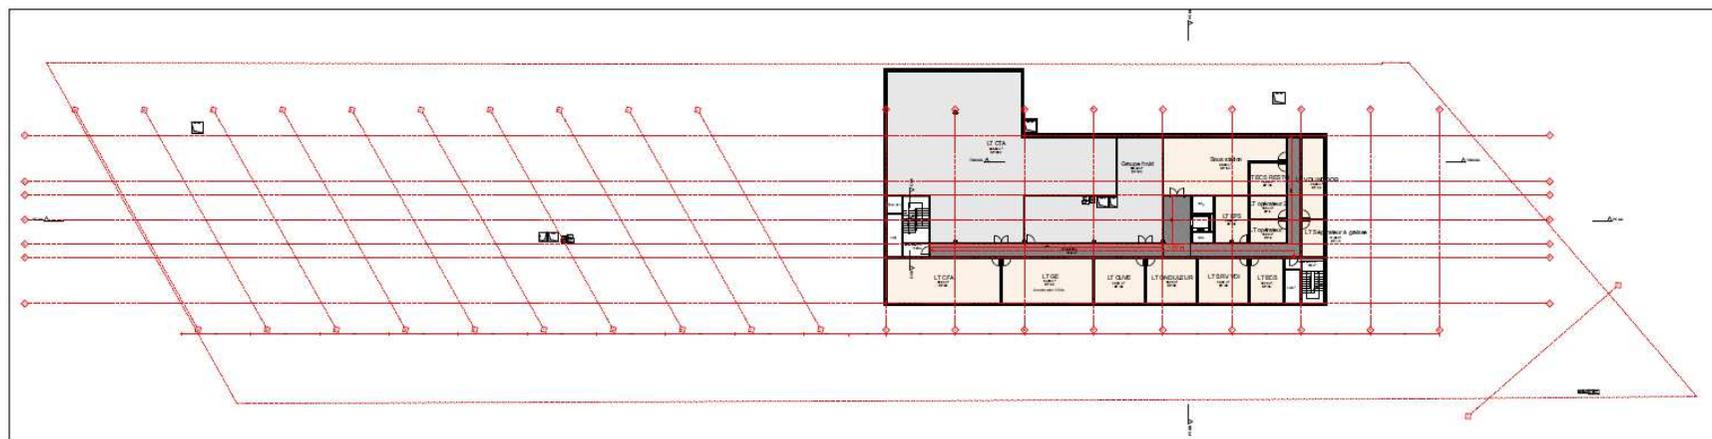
Plan des deux niveaux de sous-sol (source : Brenac Gonzalez & Associés)
